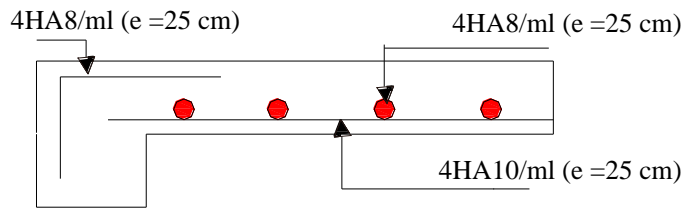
Schéma de ferrailage de la dalle pleine (D5).
